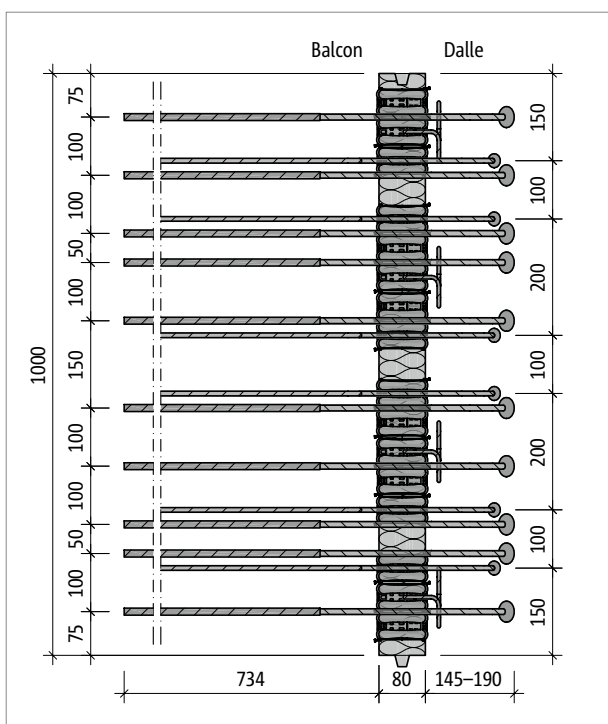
Schöck Isokorb® T type K-O-M4 : plan de base du produit
